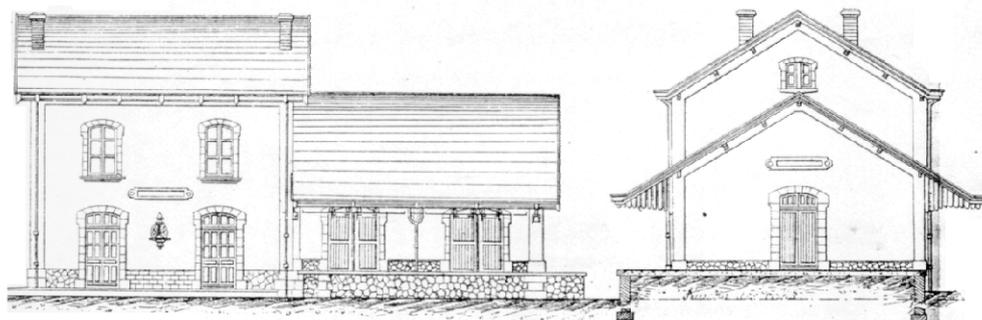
Fachadas de uma pequena estação francesa. No primeiro pavimento: o hall de acesso, sala de bagagens, escritório, vestibulo e sala do atendente. No segundo pavimento: a residência do chefe da estação.
